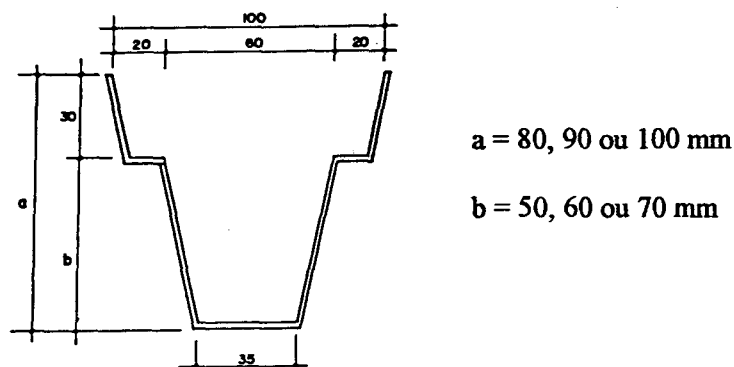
TIPO DE FÔRMA METÁLICA
